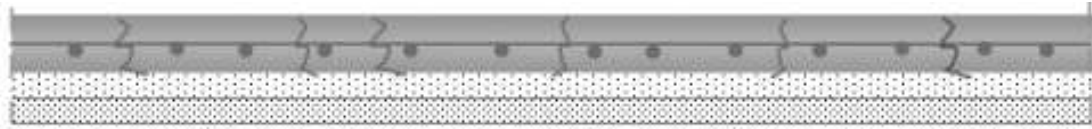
Pavimento de betão armado contínuo reforçado (elaboração própria – adaptado de Picado Santos et al, 2011)
